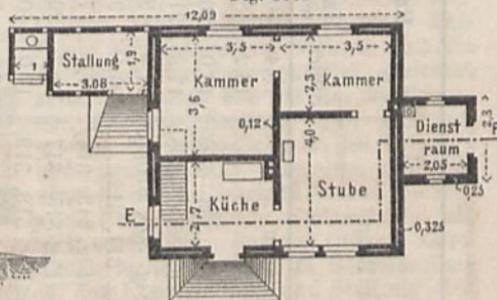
stellt den Grundriss des Erdgeschosses eines 4 Familienhauses der Niederschl.-Märk. Bahn dar. Flur und Treppe sind dabei nicht getrennt gehalten. Baukosten pro \square m Grundfläche jeder Wohnung 50 M.
